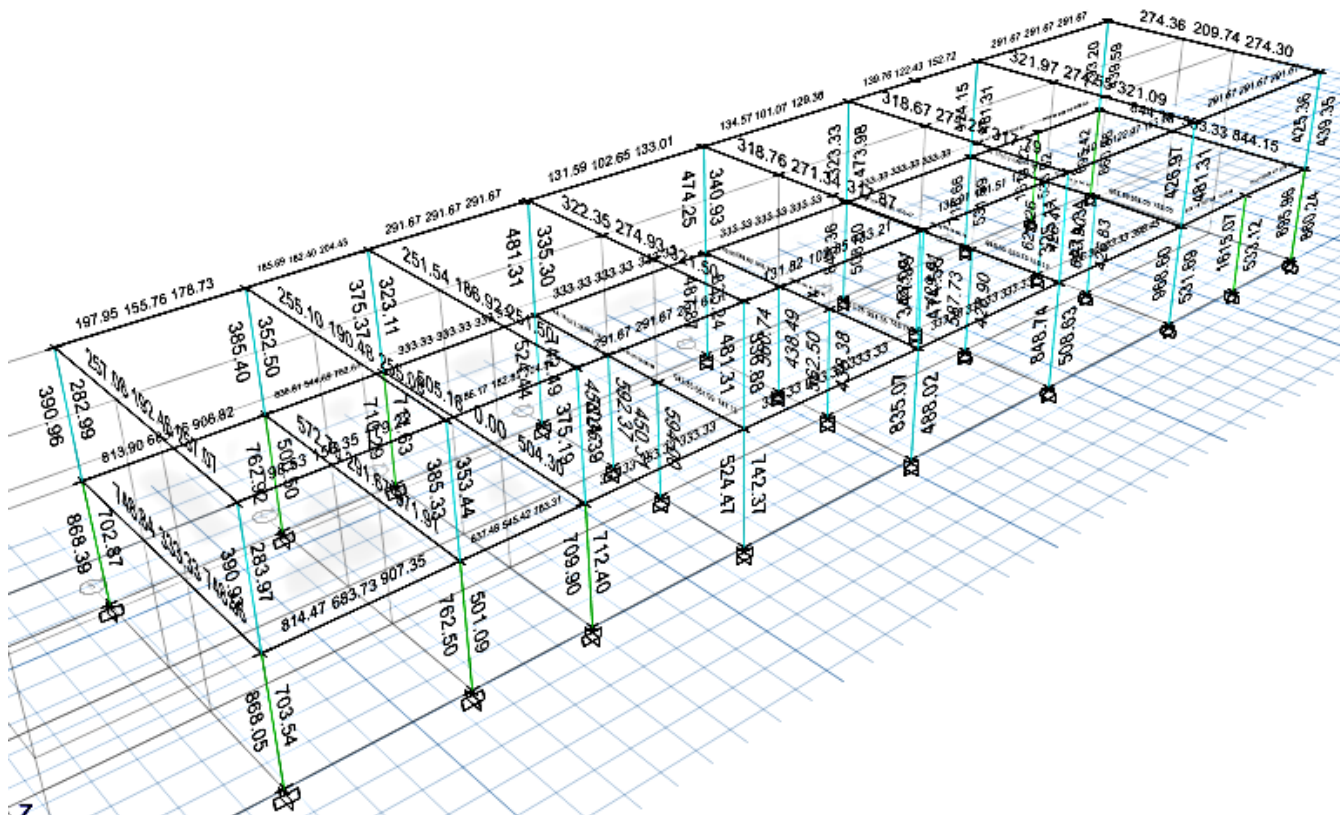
Refuerzo de acero por corte de la zona B, ETABS 2015. Fuente: Autor.
